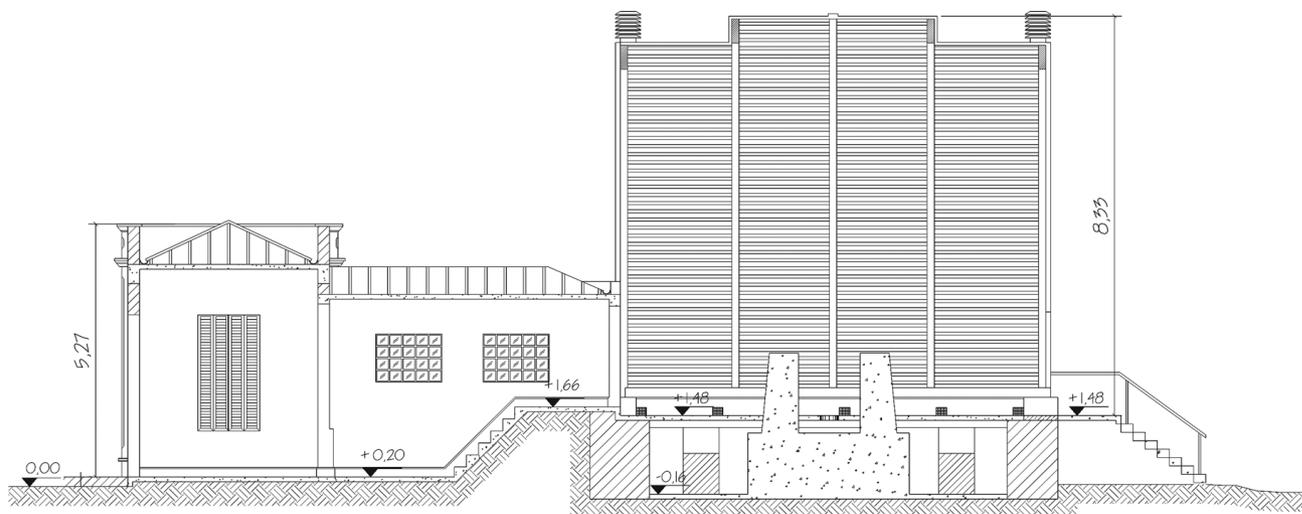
Corte CD. Desenho de reabilitação do pavilhão da luneta meridiana de Gautier. Arquivo MAST, Rio de Janeiro.
